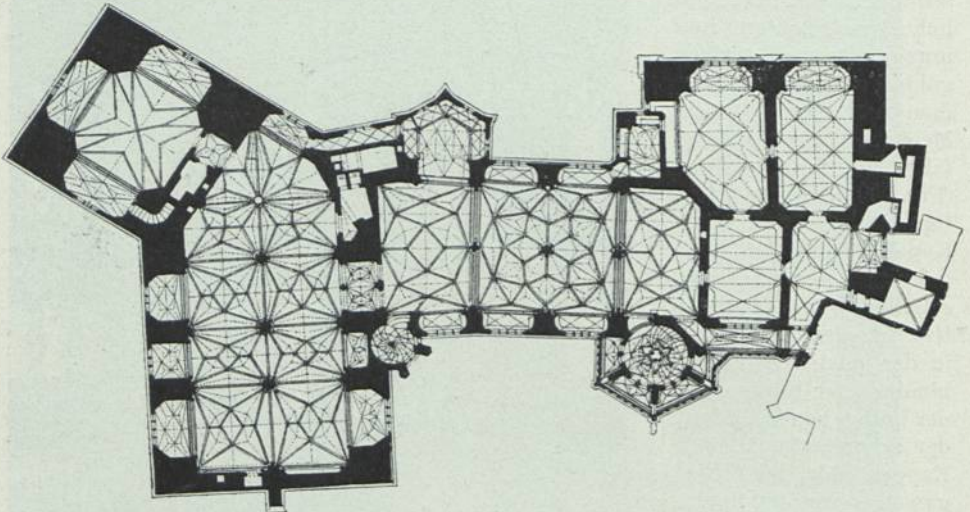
Grundriss des Hauptgeschosses der Albrechtsburg in Meissen
